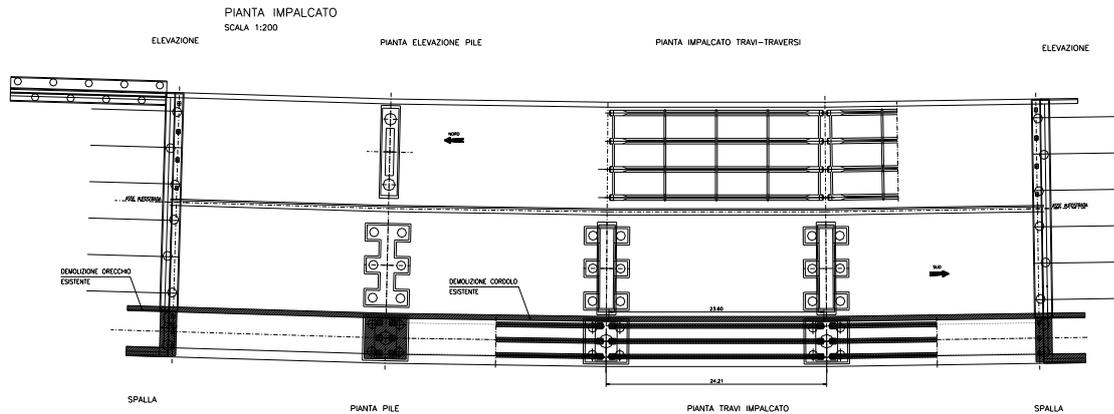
Pianta dell'impalcato del viadotto Zuane con allargamento
